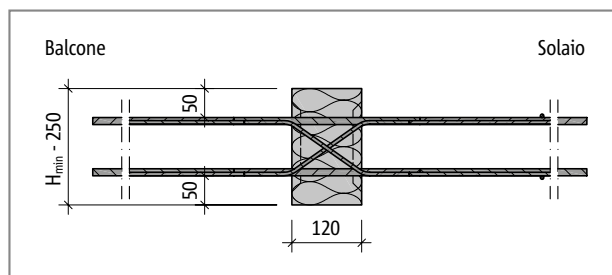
Schöck Isokorb® tipo DXT per CV50: sezione dell'elemento
